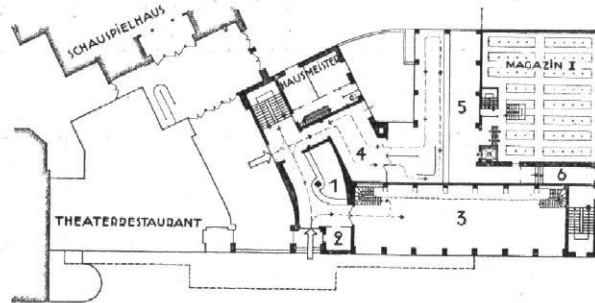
/ Neubau Stadtbücherei Essen / Architekten: G. Metzendorf und J. Schneider, Essen / Grundriß des Erdgeschosses 1:800
